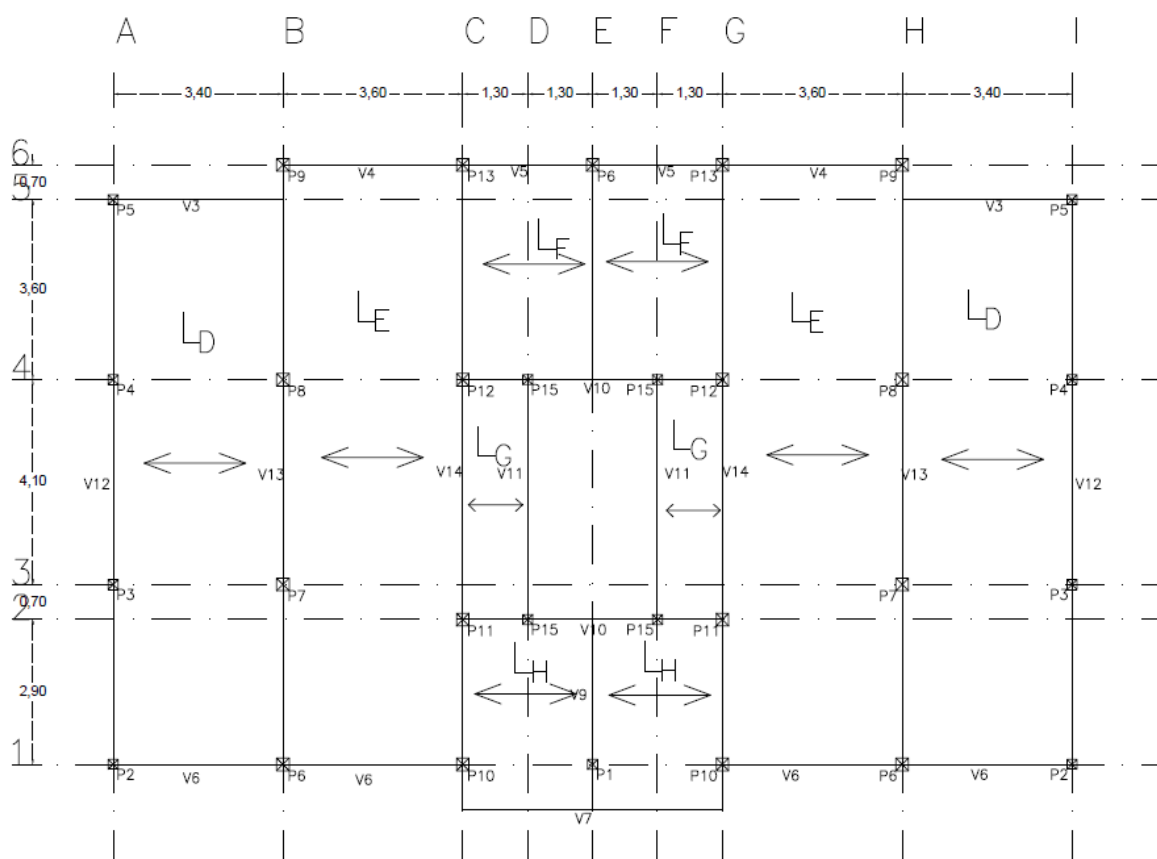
Piso 4 -Plantas de distribuição das lajes aligeiradas
